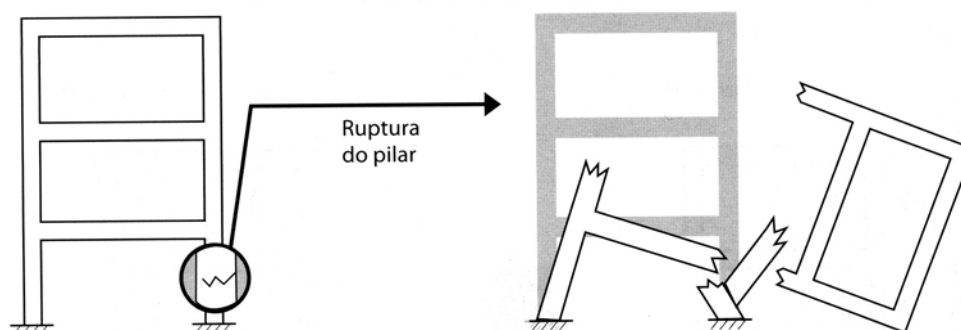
Ruptura do pilar (KIMURA, 2007).
